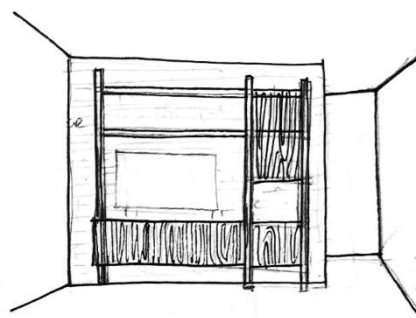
Esboço de vista transversal da sala: estudo de móveis.
